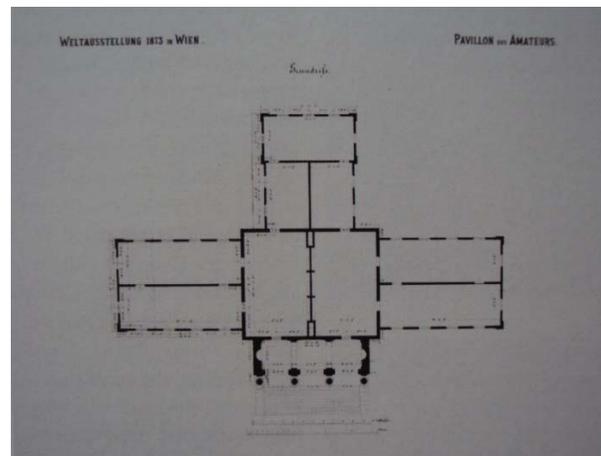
Carl von Hasenauer Grundriss, Pavillion des amateurs
